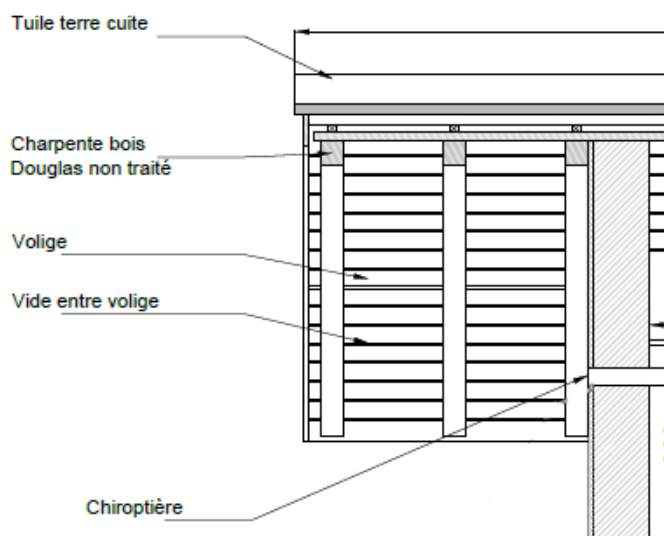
Plan de la toiture faisant figurer les voliges et l'espacement entre les voliges (Source : CD54)
